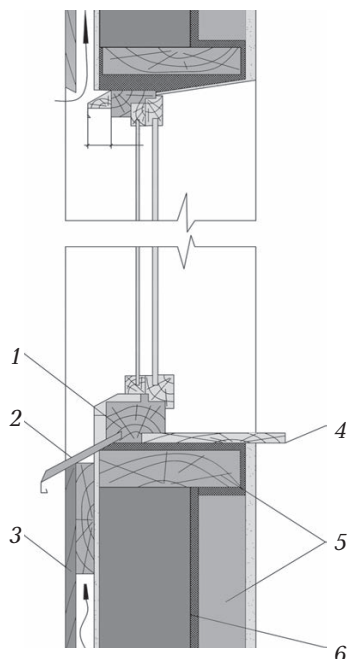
Установка окна в каркасную стену: 1 — окно; 2 — отлив оцинкованный; 3 — наружная обшивка каркаса; 4 — подоконник; 5 — брус каркаса стен; 6 — утеплитель
